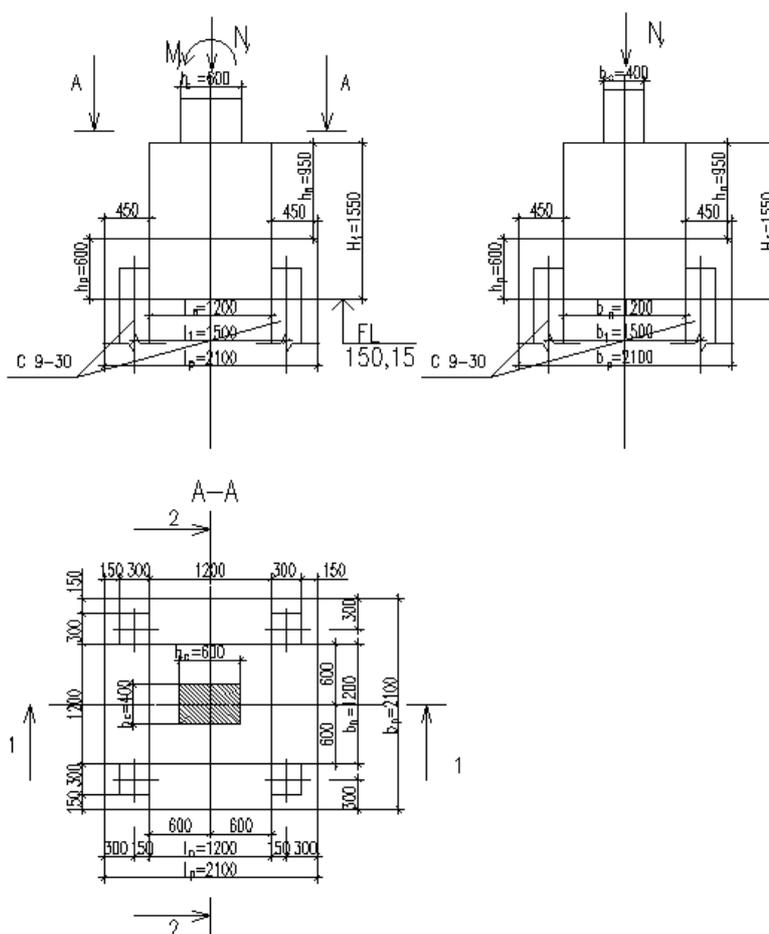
Конструирование ростверка свайного фундамента СФ-1
